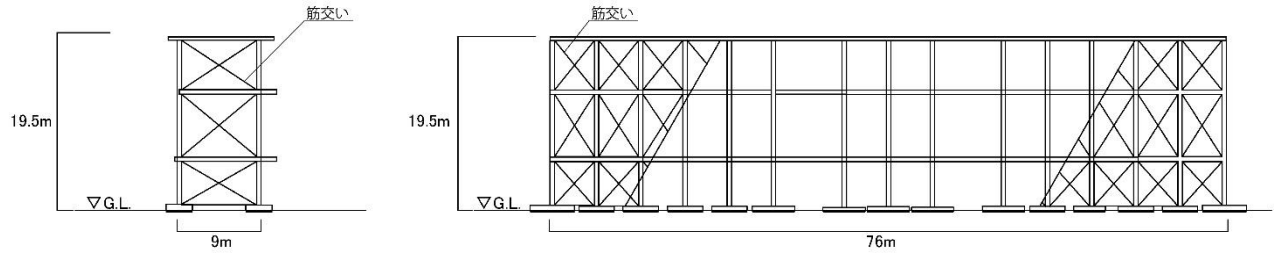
(1) 断面図 (A 設備架台、B 設備架台、F 設備架台)
